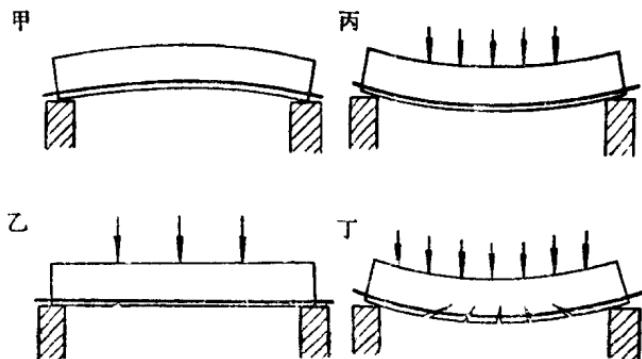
预应力钢筋混凝土梁承受荷载的几个阶段
